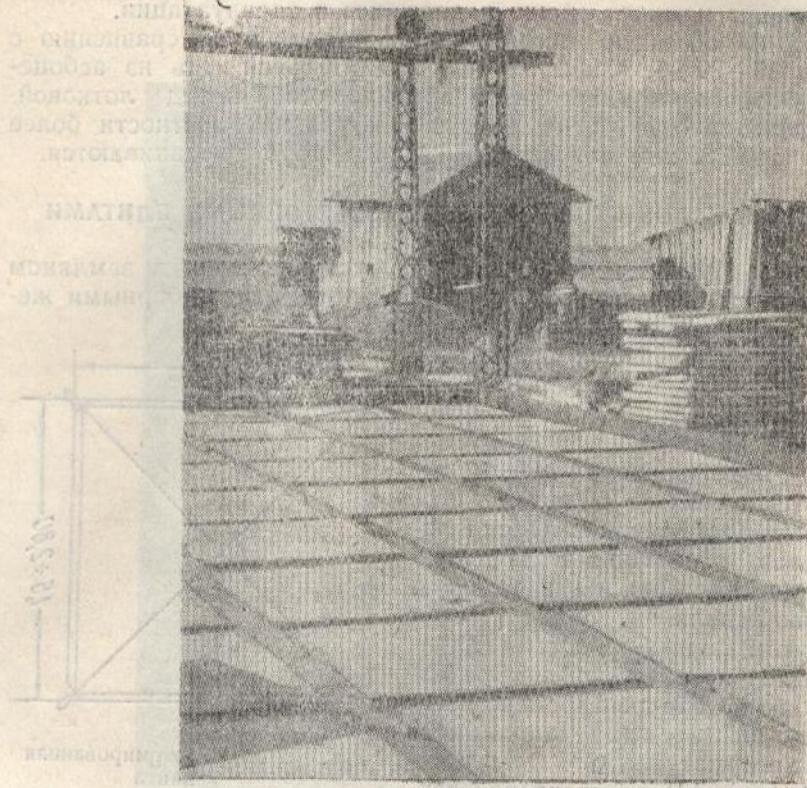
Изготовление железобетонных облицовочных плит стендовым способом.
